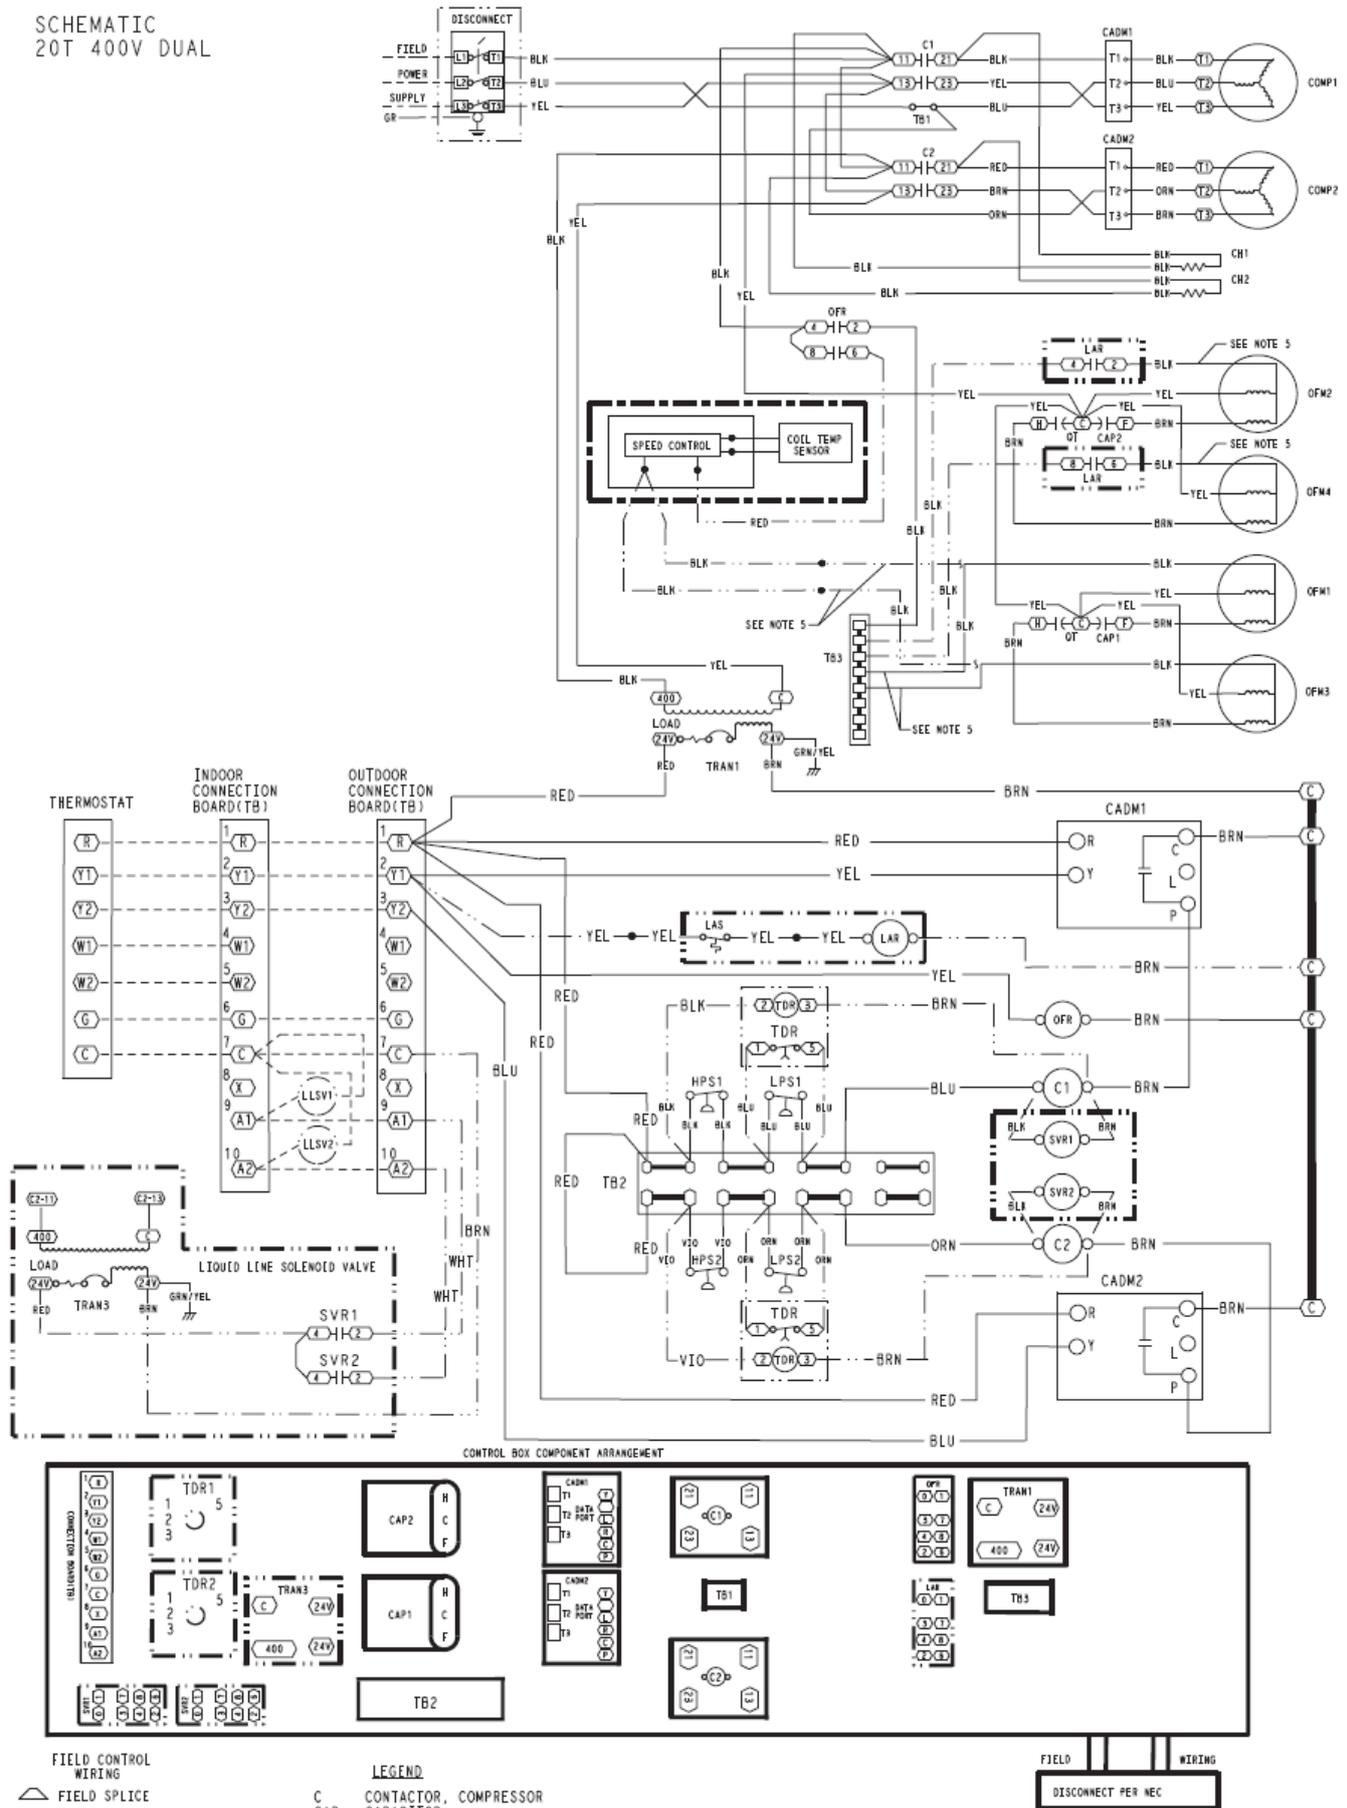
Типовая схема монтажа электропроводки блока 38AUD*25
